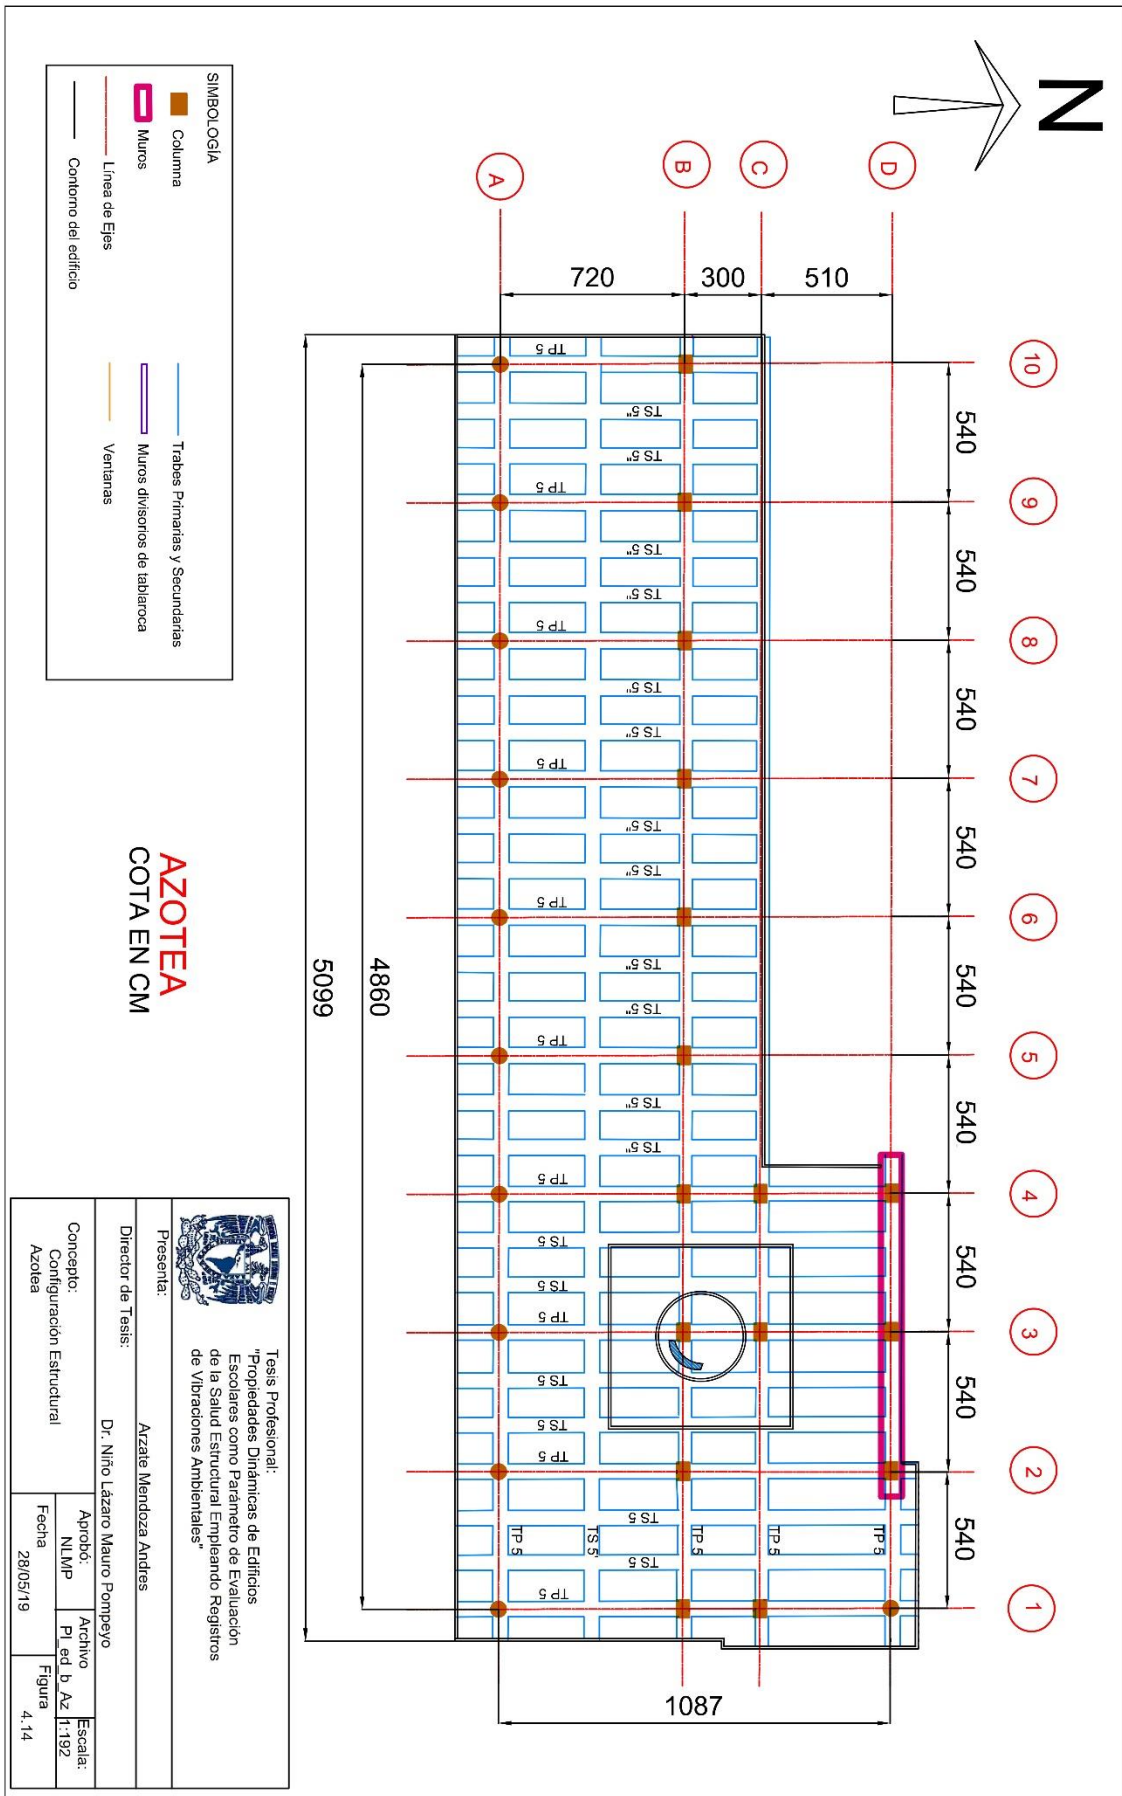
Planta estructural azotea edificio B FI, UNAM
